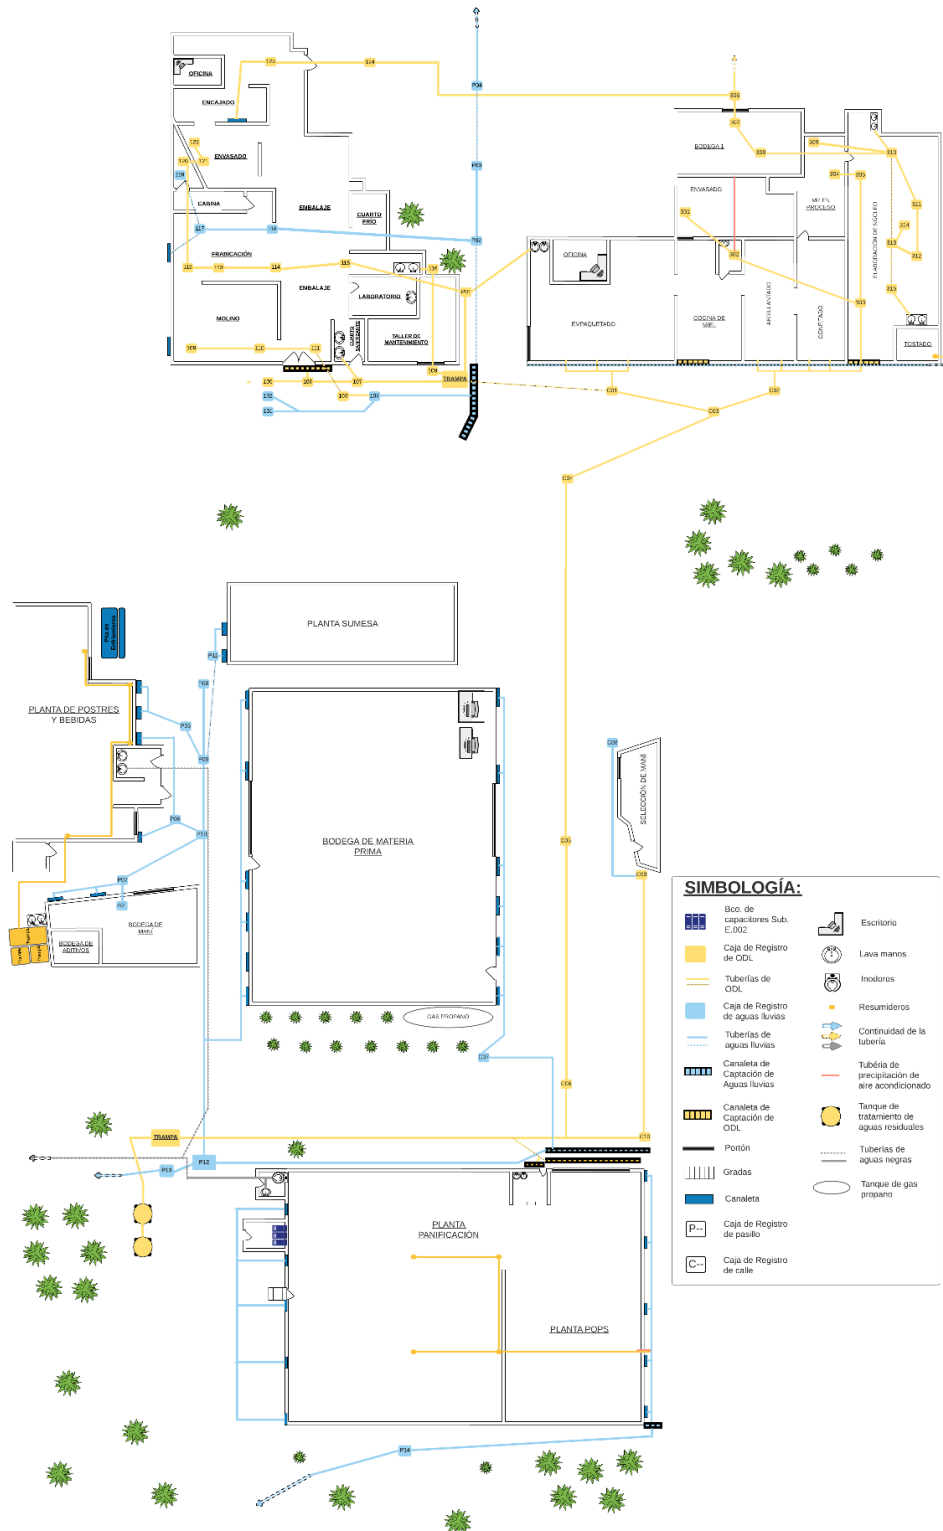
Ilustración de red de Alcantarillado General de las Plantas de Procesamiento.
